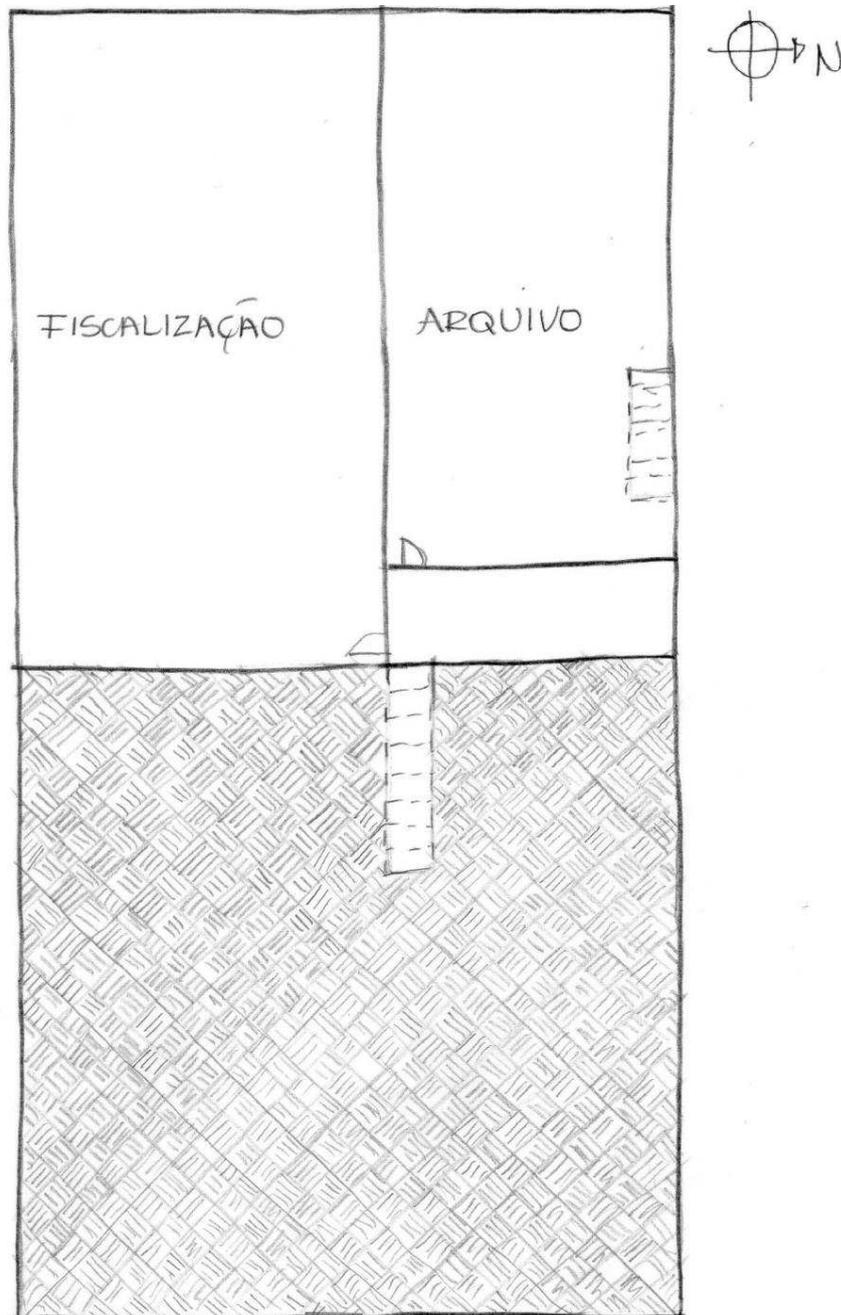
Croqui Planta Baixa Subsolo CREA/MA
